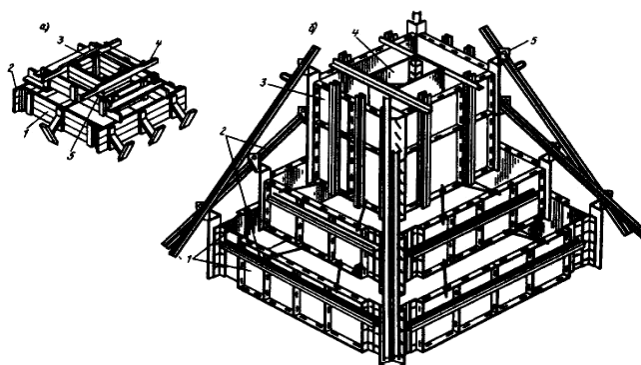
Щитовая опалубка ступенчатых фундаментов стаканного типа под колонны:
